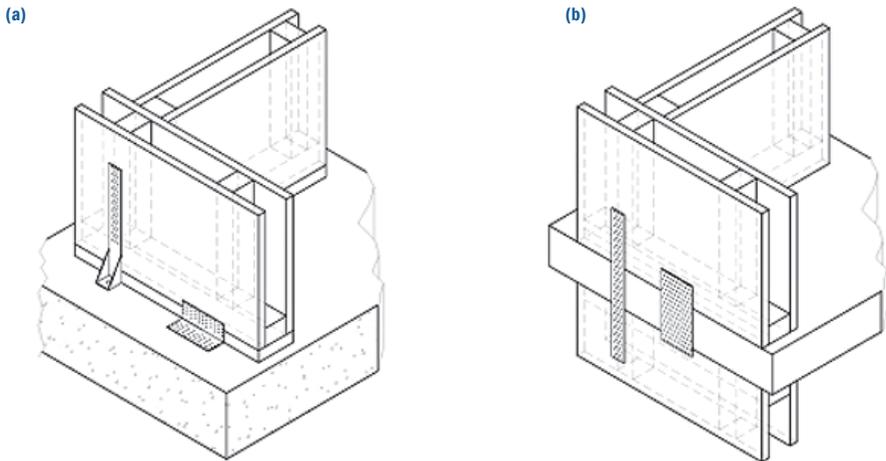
Dispositivi meccanici utilizzati per il collegamento delle pareti a terra (a) e ai piani (b)
